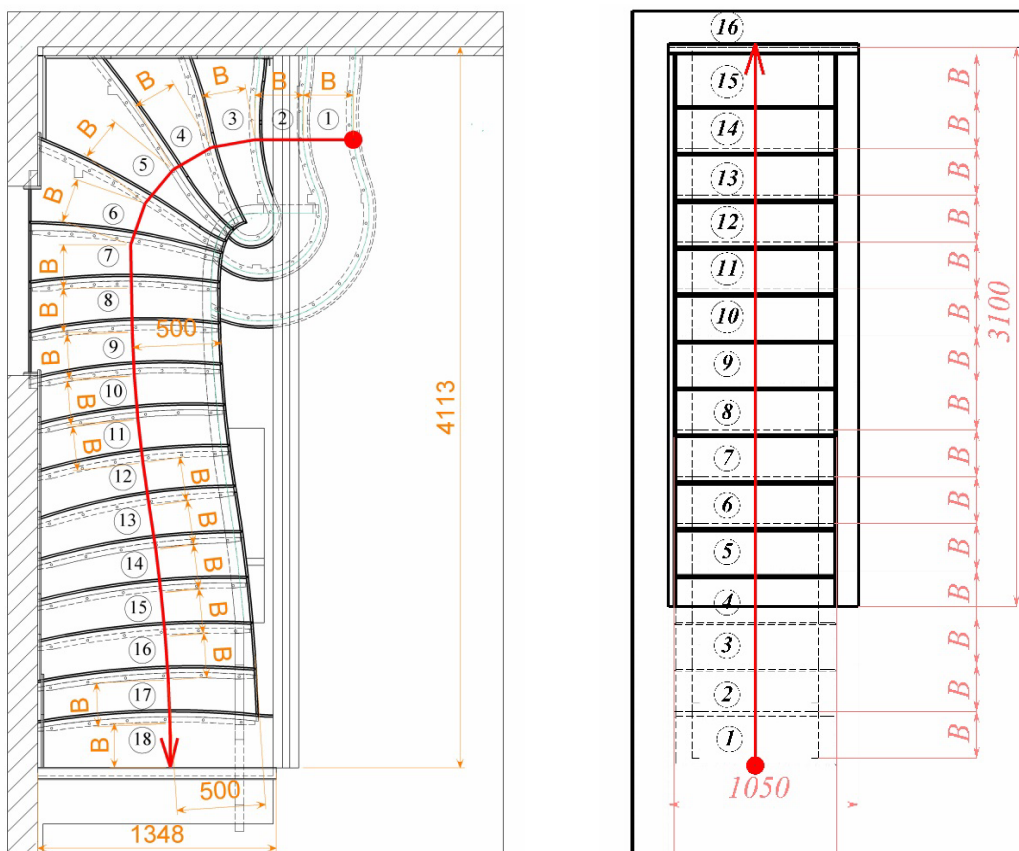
План лестницы с прямым маршем, план радиусной лестницы с изменяемым радиусом и пригласительными ступенями
